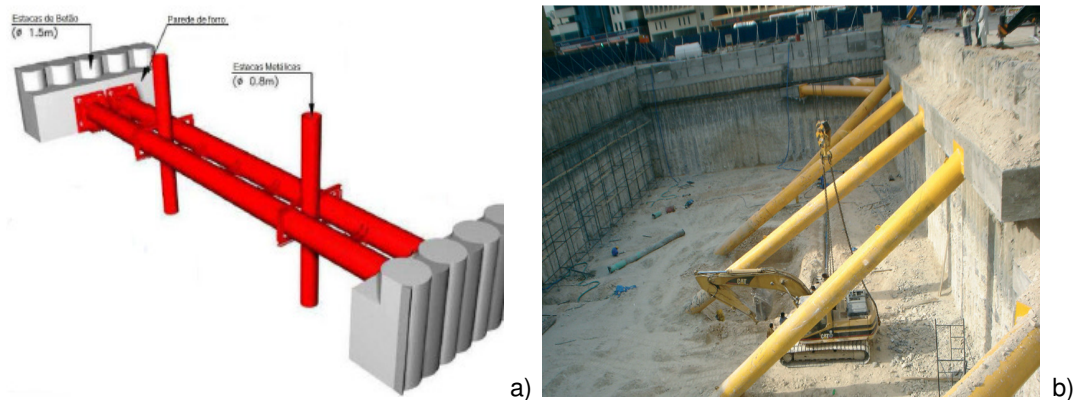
a) sistema de travamento de escoras (adaptado de Brito, 2006); b) escavação com escoras inclinadas apoiadas no terreno (PlanningEngineer, 2003)
